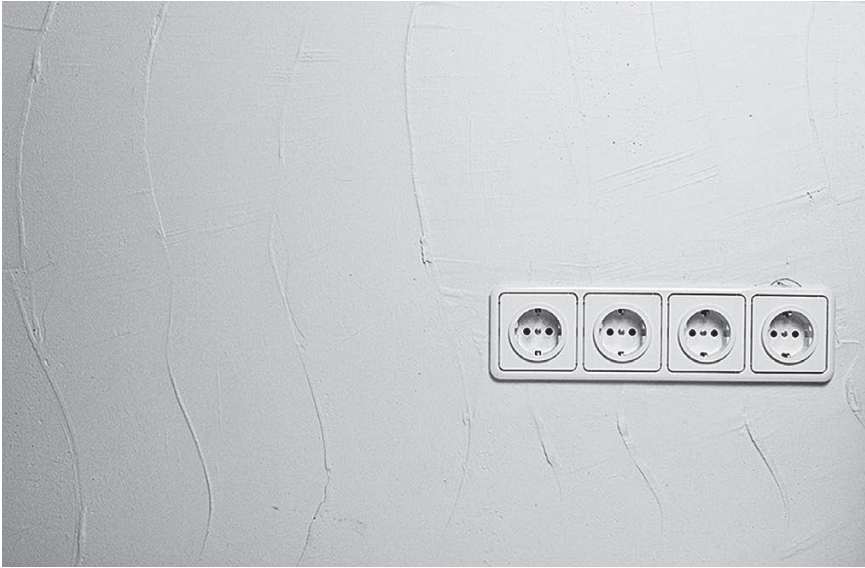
Скрытая проводка кабеля в стенах, отделанных гипсокартоном
